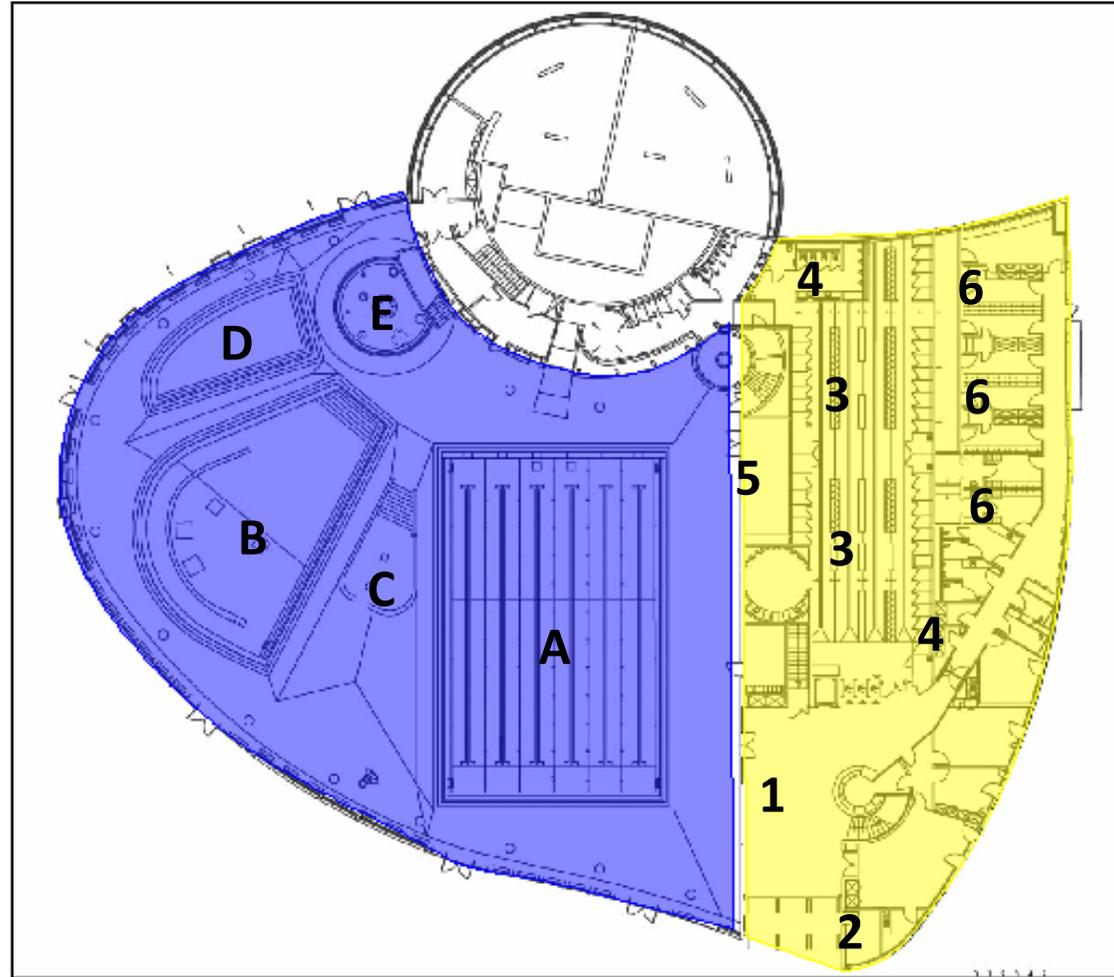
Vue en plan des espaces de rez-de-chaussée
